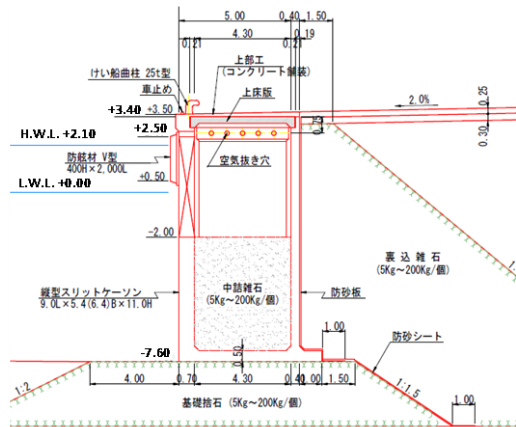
那覇港・浦添地区-7.5m岸壁 断面図
